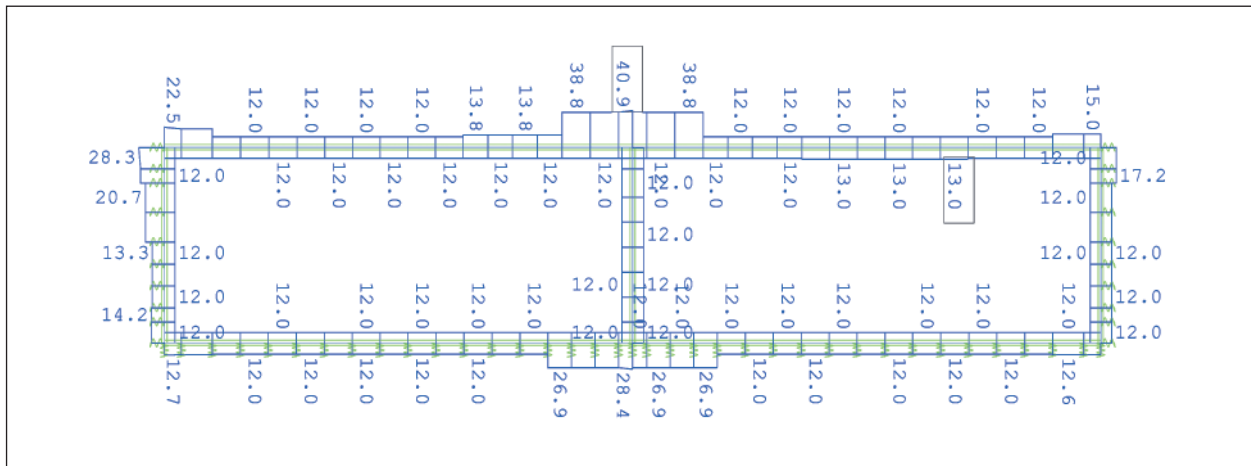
Erf. Bewehrung außergewöhnliche Bemessungssituation Brand [cm²/m]
